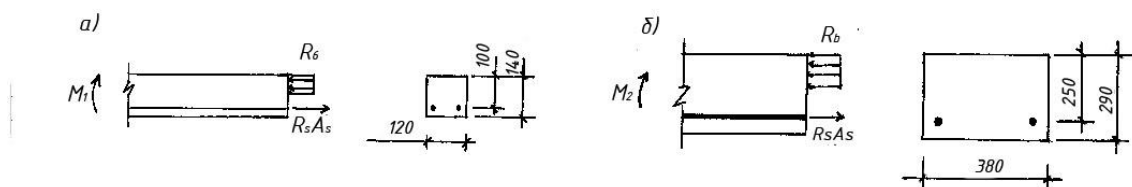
Схема армування прогона: а—переріз 140х120; б—переріз 380х290.
